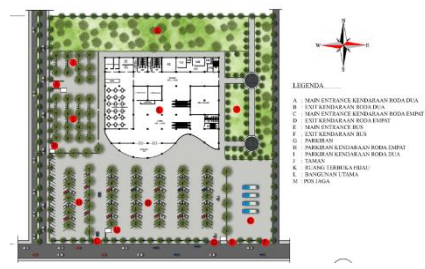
Tampilan Bangunan (Sumber : Analisis pribadi, 2024)
